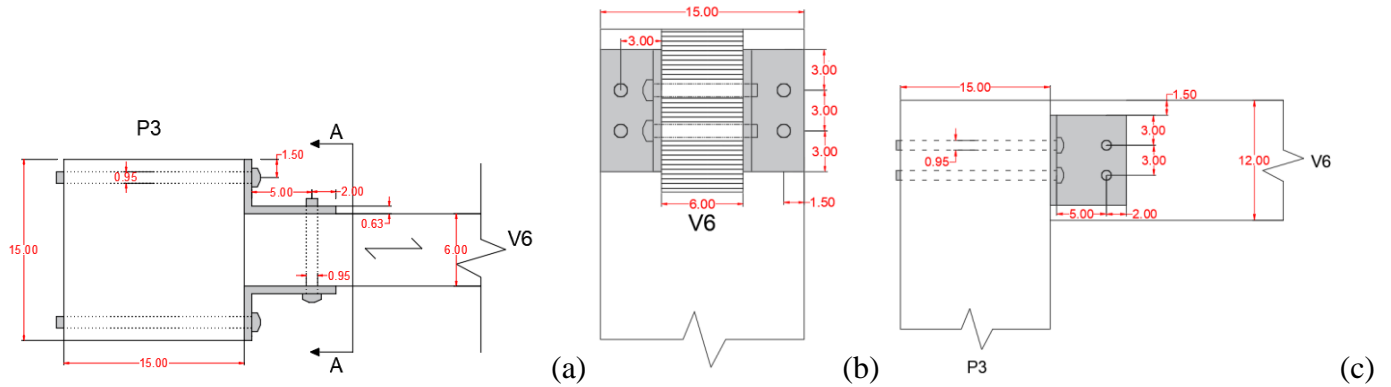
Ligação viga-pilar: (a) Vista superior. Detalhe; (b) Corte A-A; (c) Vista lateral
